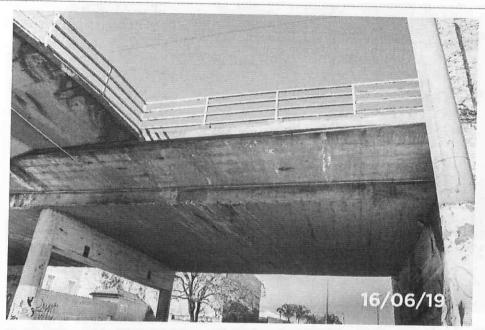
Vista da face inferior do tabuleiro no encontro com a passarela, apresentando armadura exposta, desplacamento de concreto, infiltração, eflorescência e tubulação elétrica.
